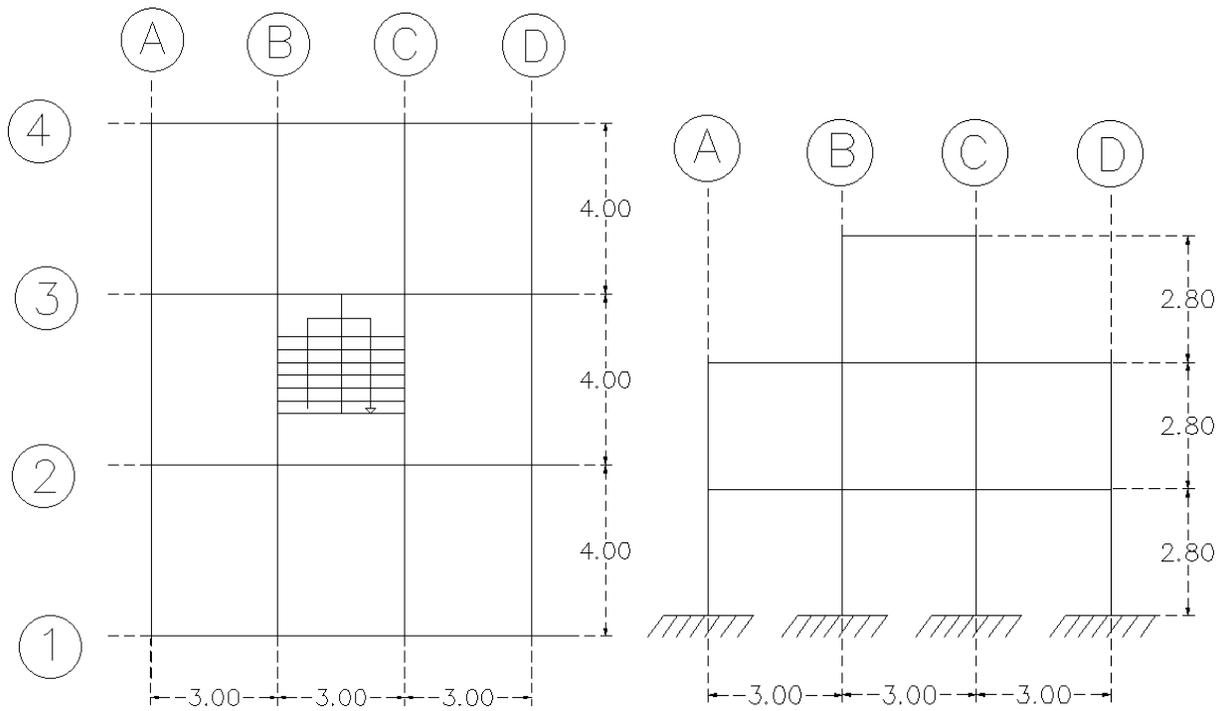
Vista en planta y elevación frontal de la edificación de dos plantas.
